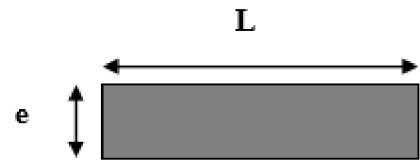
Vue en plan et en coupe des refends.
